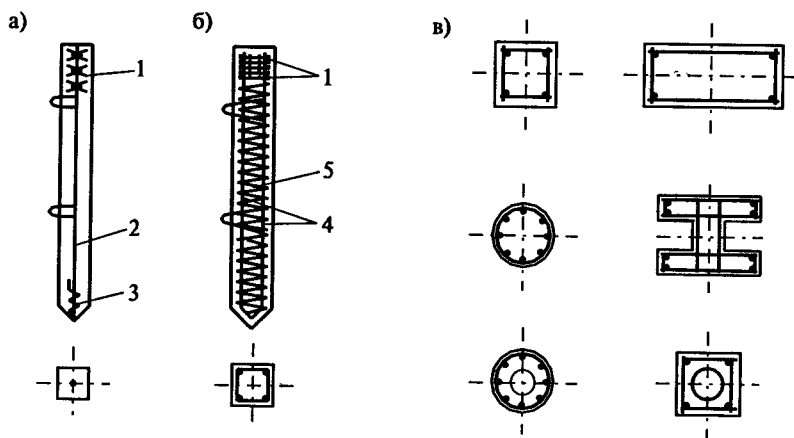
Армирование свай; формы поперечного сечения свай: а) свая без поперечного армирования; б) свая с поперечным армированием; в) сечения свай; 1 — арматурные сетки; 2 — предварительно напряженный стержень; 3 — арматурная спираль; 4 — стержни арматурного каркаса; 5 — навивка арматуры в виде спирали
